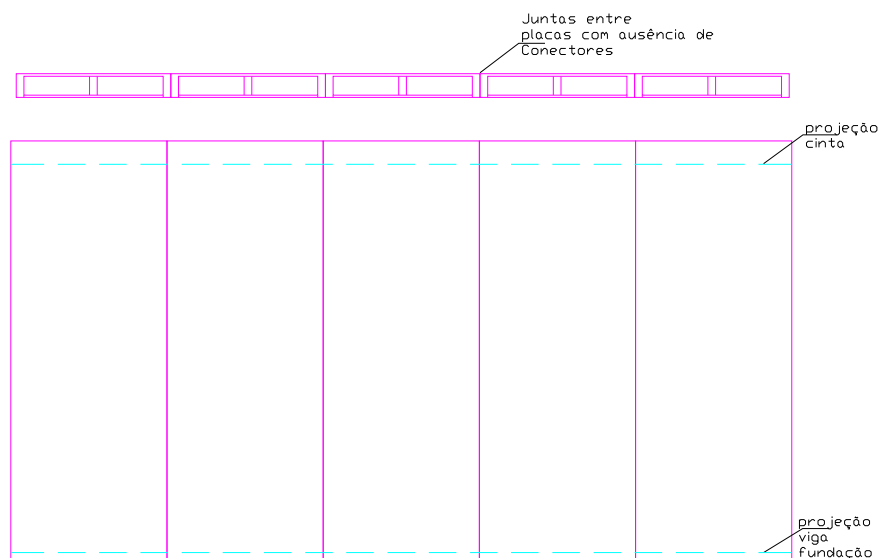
Conexão dos painéis referente à segunda alternativa de sistema construtivo.
